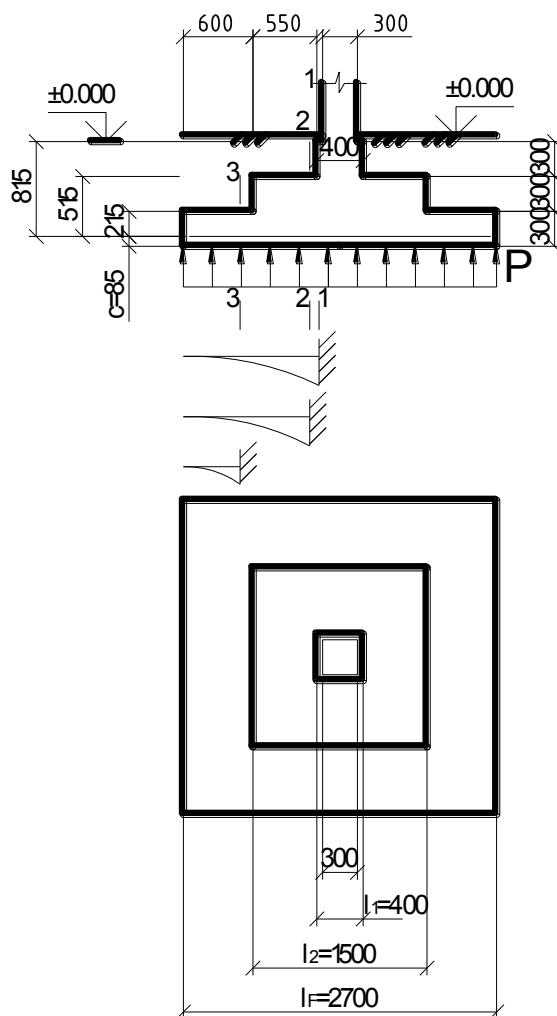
Расчетная модель столбчатого плитного центрально-нагруженного фундамента
